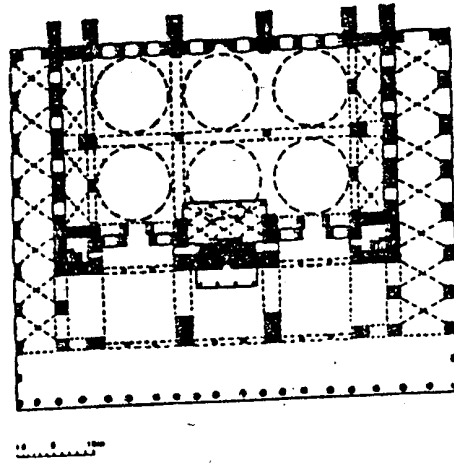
مسقط أفقي لجامع العاقولي ببغداد
